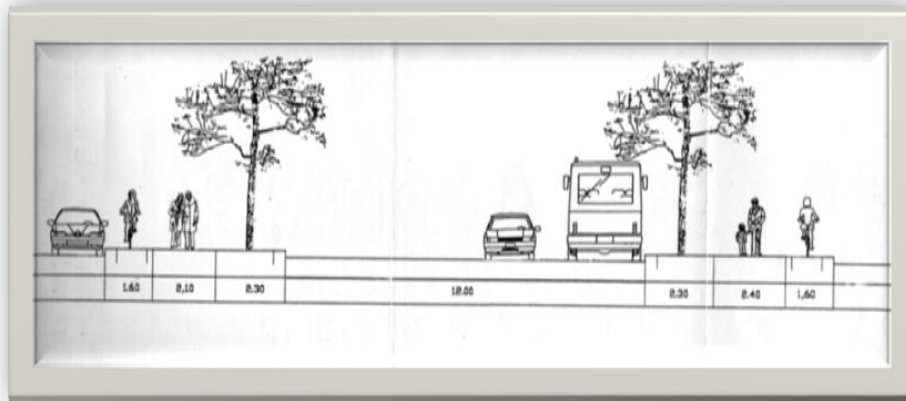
Sezione tipo secondo la soluzione progettuale proposta – via Libertà
